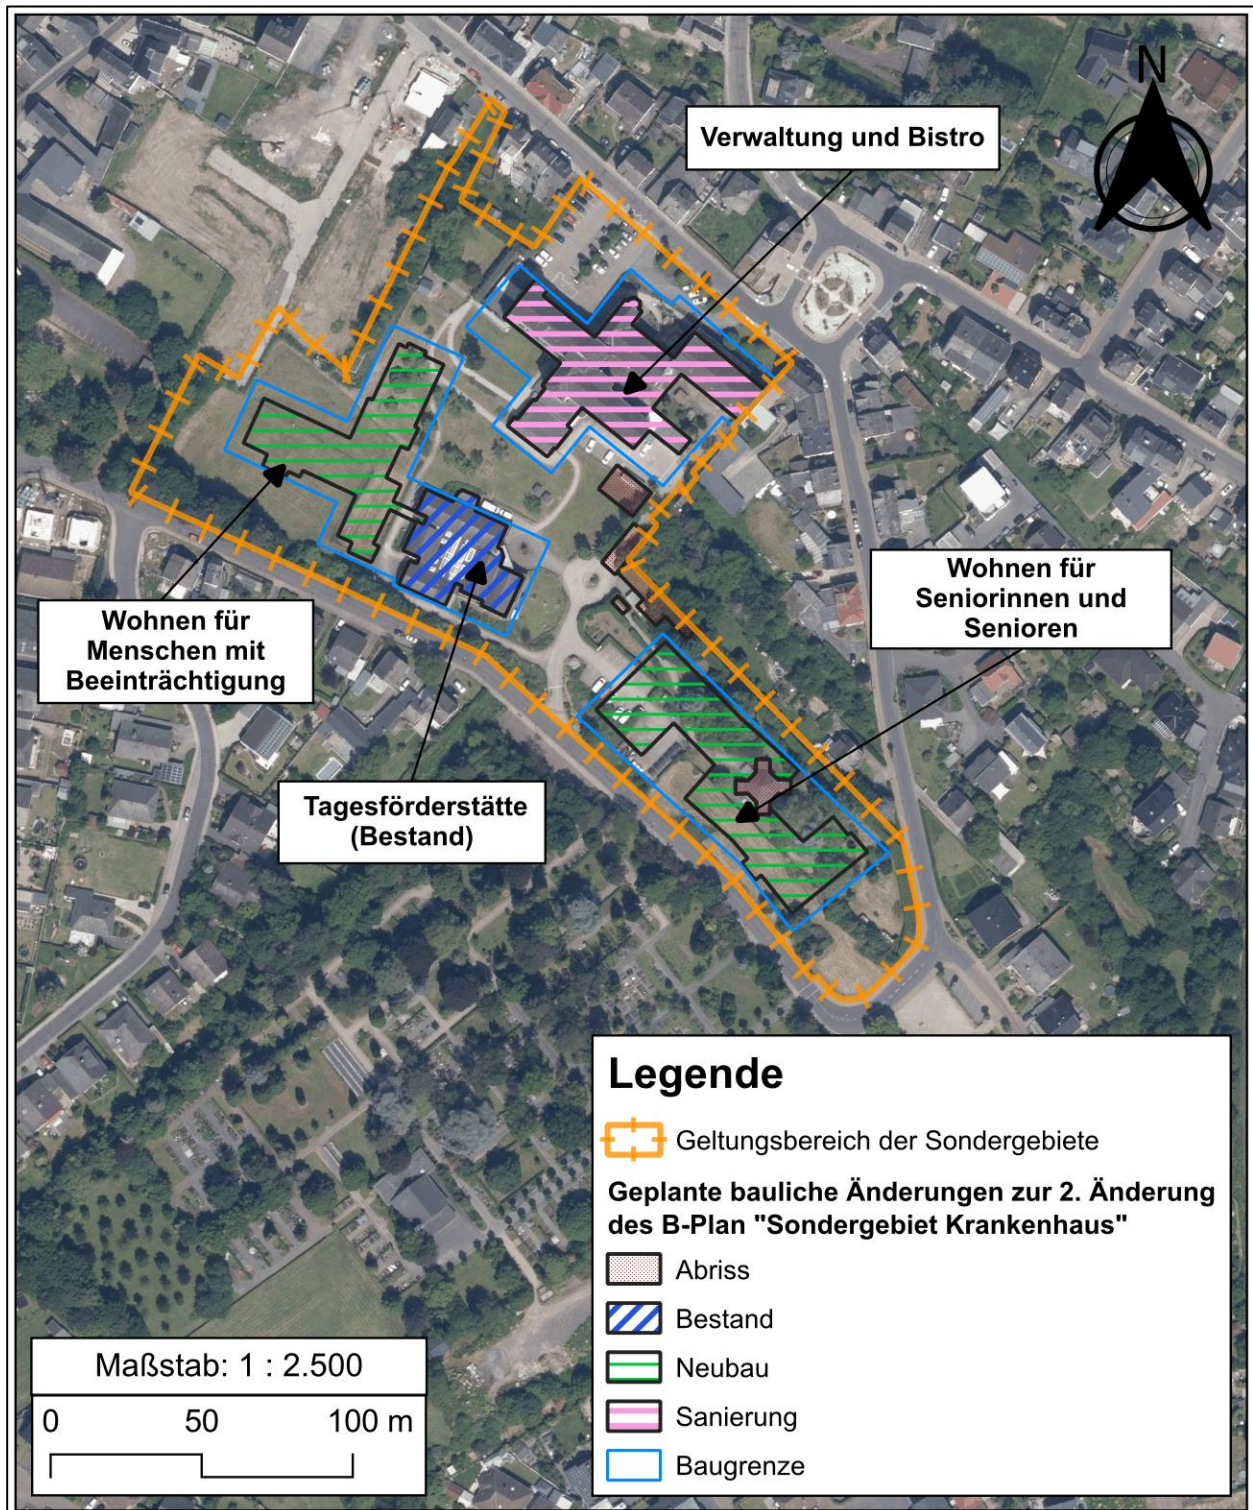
Geplante bauliche Änderungen zur 2. Änderung des B-Plan "Sondergebiet Krankenhaus"
